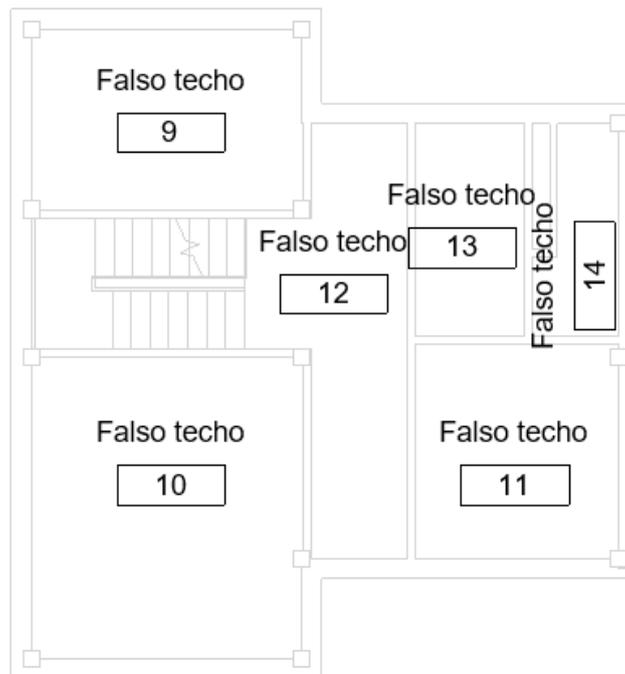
Espacios de falsos techos de planta baja colocados y nombrados. Fuente: propia
